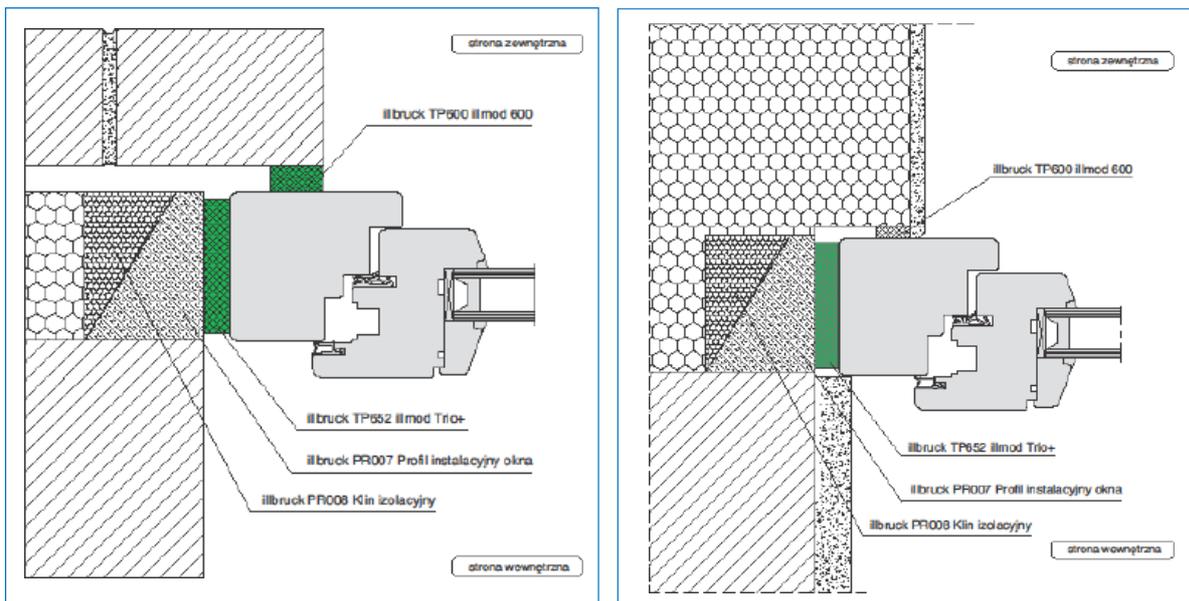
Querschnitte des Fenstereinbaus in der Wärmedämmschicht
